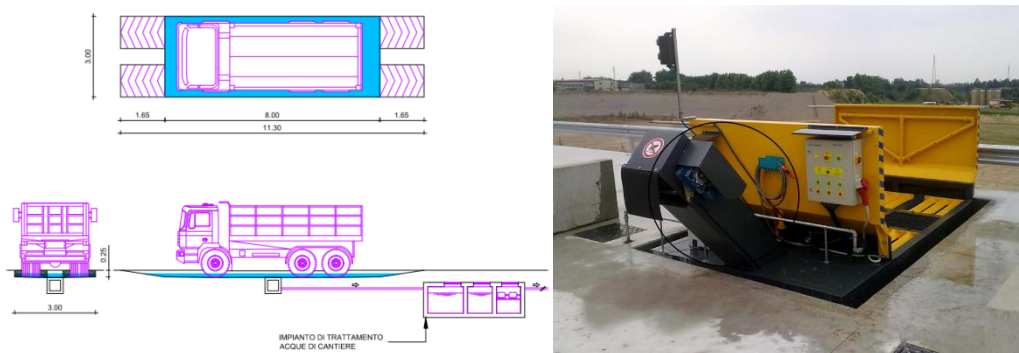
Impianto di lavaggio mezzi tipo A nei cantieri fissi
